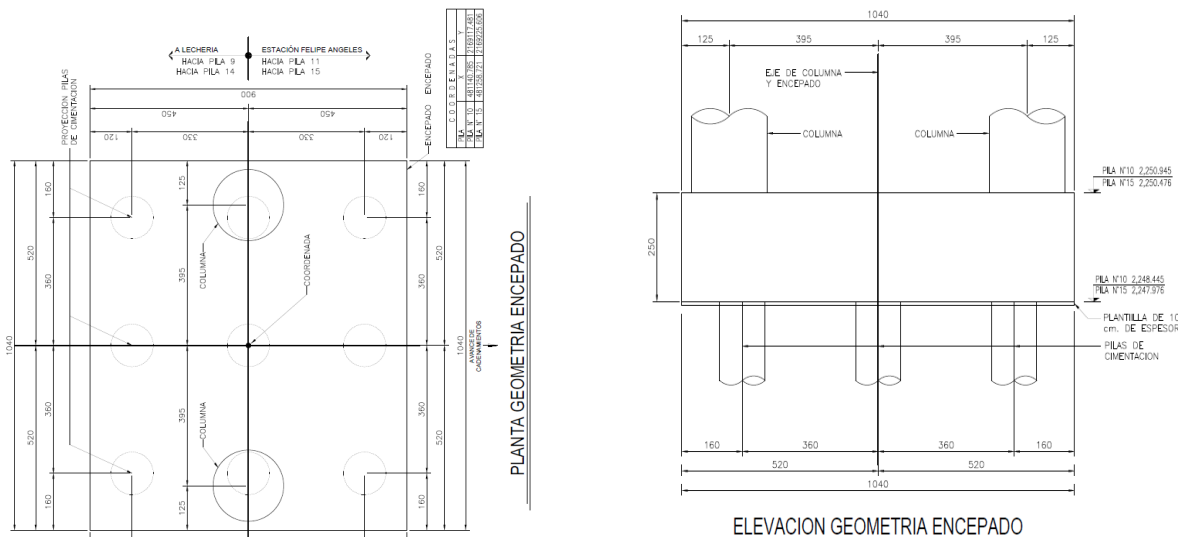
y 85 ARI Ingeniería (2023) "Geometría de zapatas para pórticos (Apoyo 10 y 15)"
